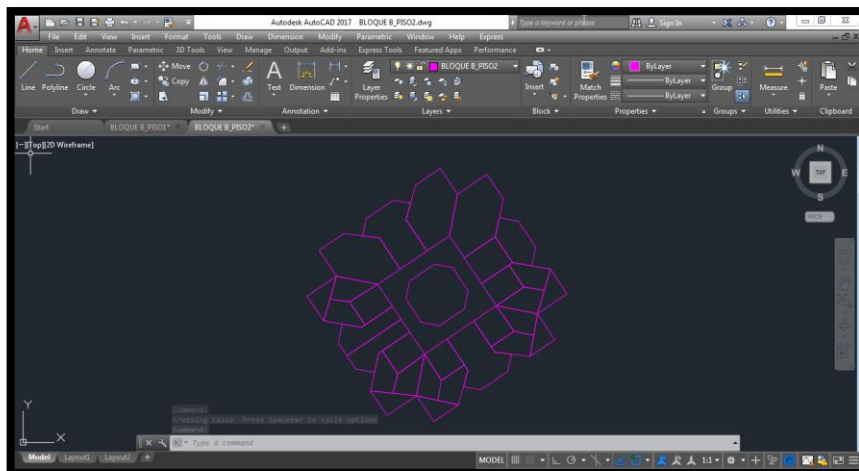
Levantamiento en AutoCAD del piso 2, Bloque B
